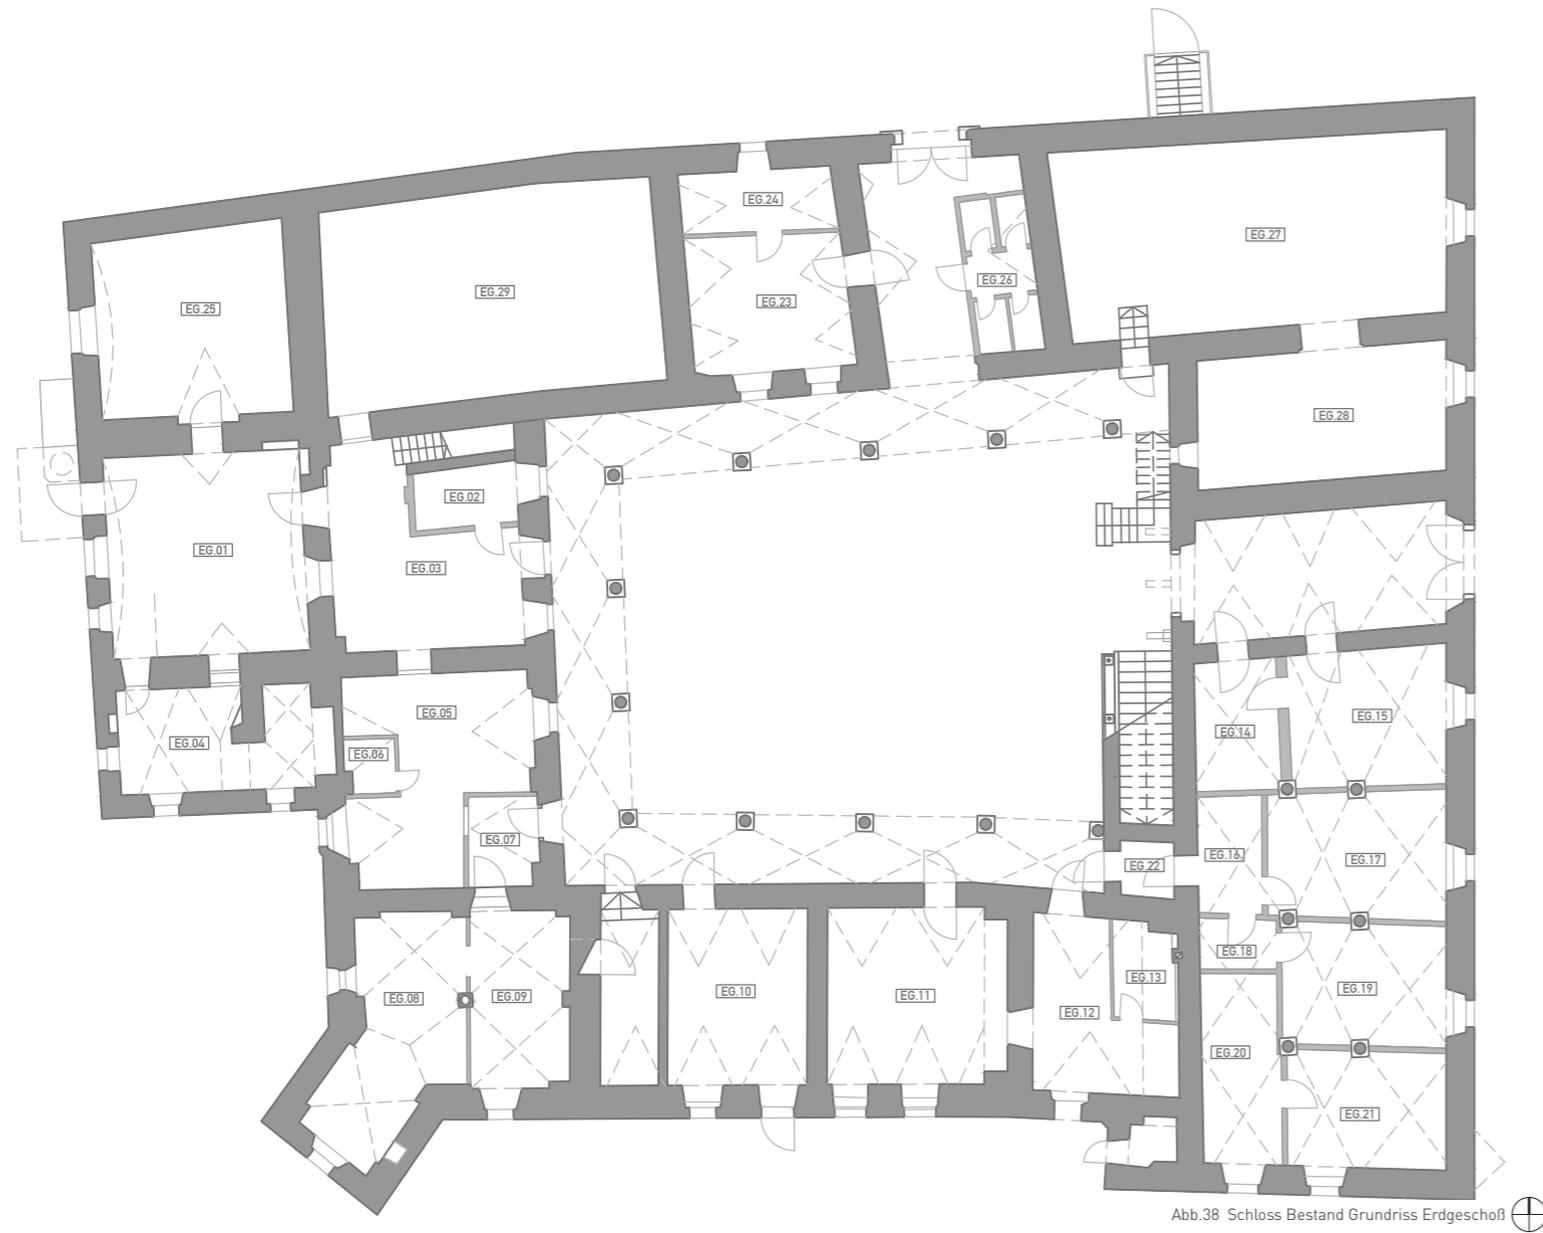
Schloss Bestand Grundriss Erdgeschoß
